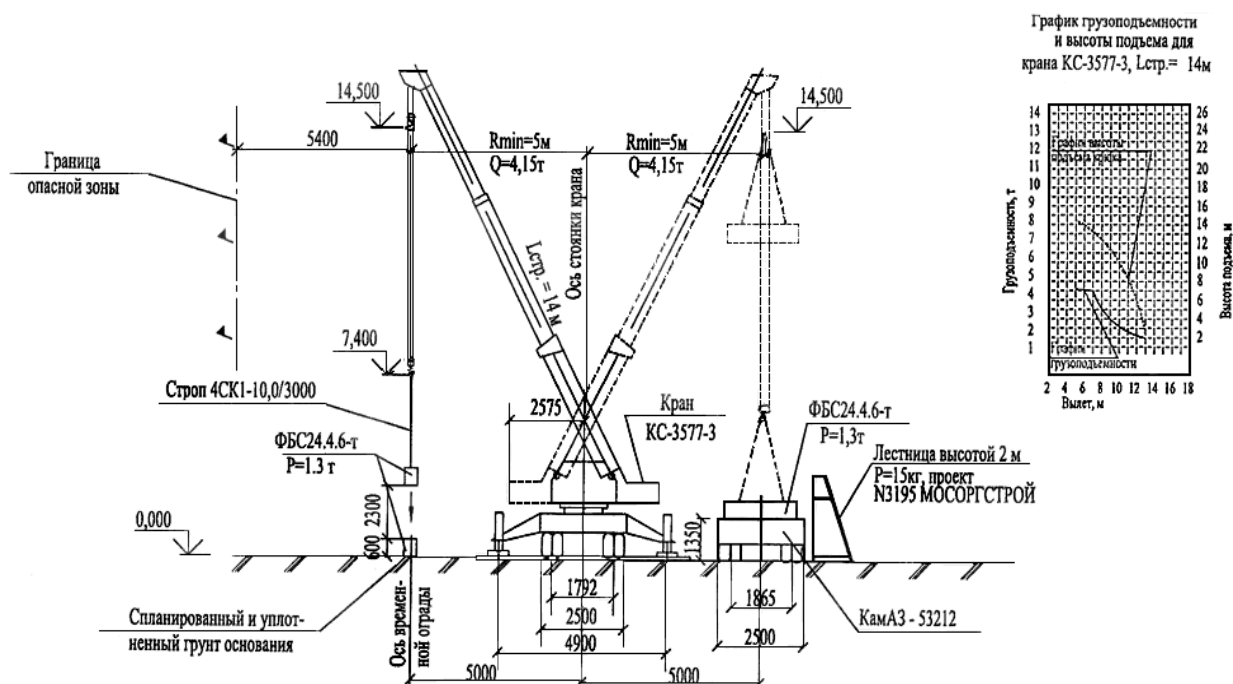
Схема разгрузки и подачи фундаментных блоков в зону монтажа
